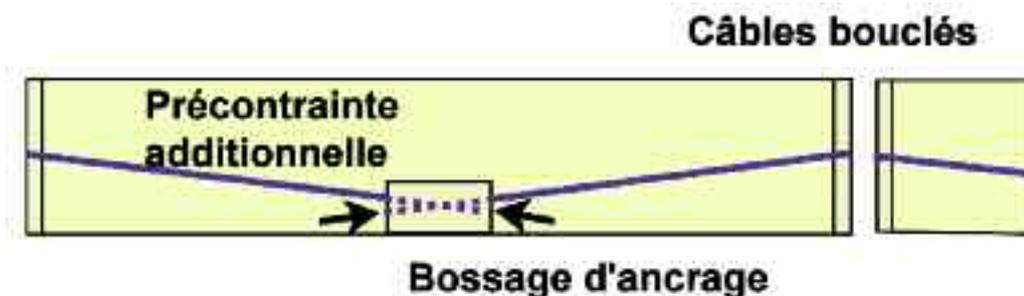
principe de câblage de renfort d'une travée d'un VIPP
